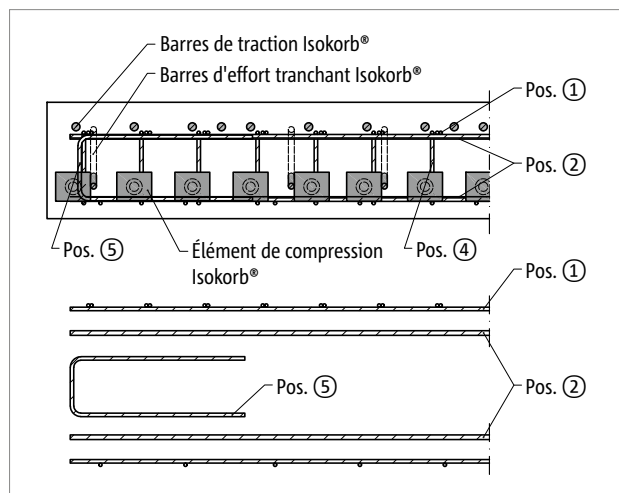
Schöck Isokorb® T type K-M12 : armature sur site côté balcon en coupe A-A ; Pos. 5 = bordure constructive sur bord libre
